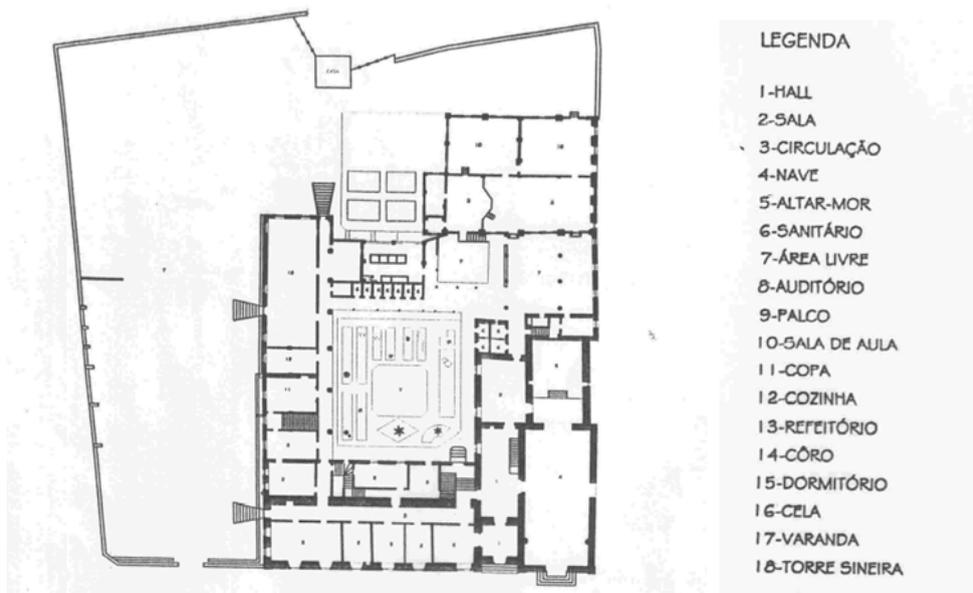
Planta baixa do pavimento térreo da Igreja e Casa da Misericórdia/ Lar Imaculada Conceição - SE.
